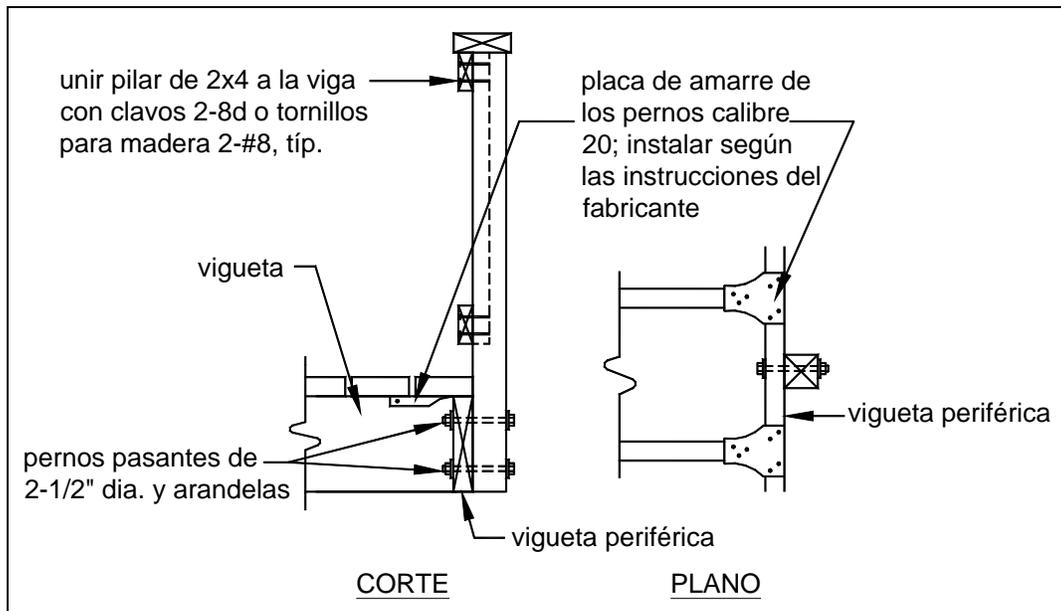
DETALLE DE UNIÓN DEL PILAR DE LA BARANDA A LA VIGUETA PERIFÉRICA, OPCIÓN 2
